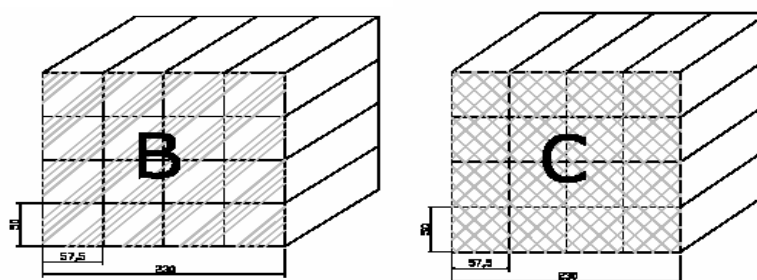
Estruturas M – 3 e M – 4, respectivamente
